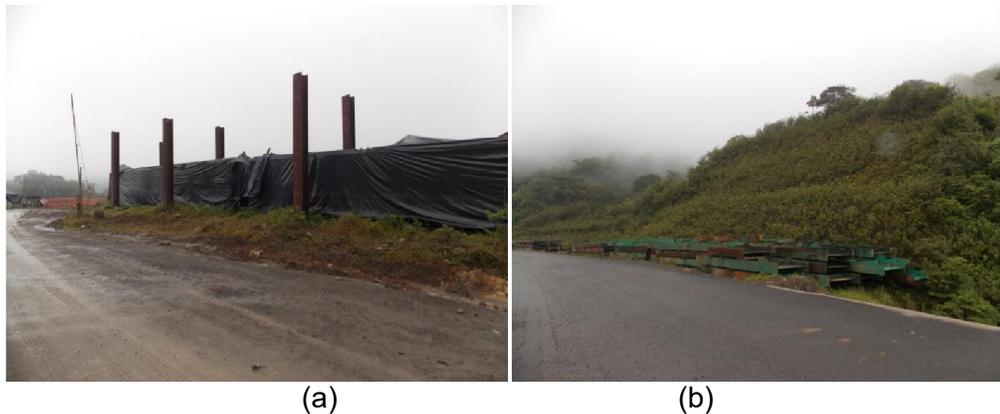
Almacenamiento de vigas metálicas para el puente sobre el río Espino. (a) Protegidas con plástico. (b) Sin protección.
